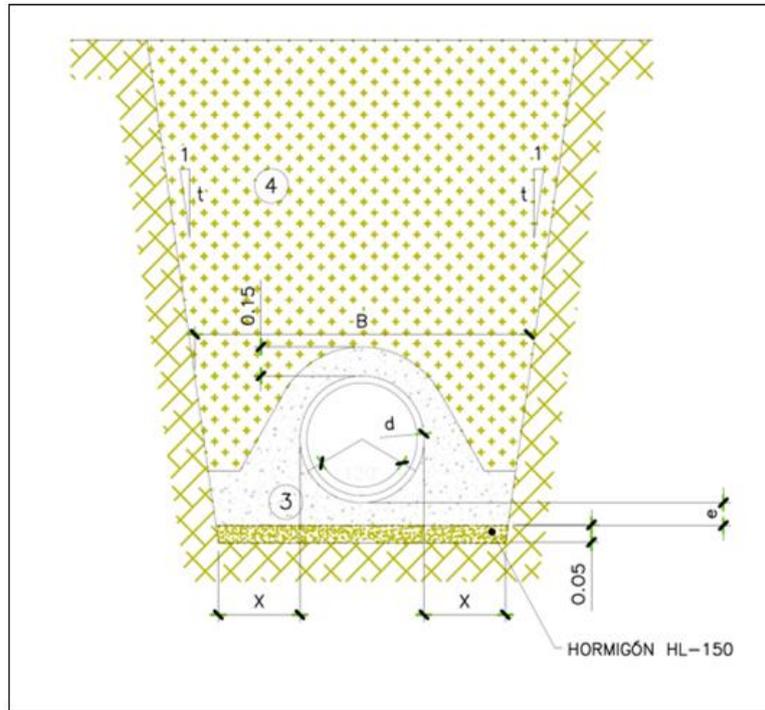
Tubo de hormigón en masa en sección reforzada con hormigón en lecho de asiento.
